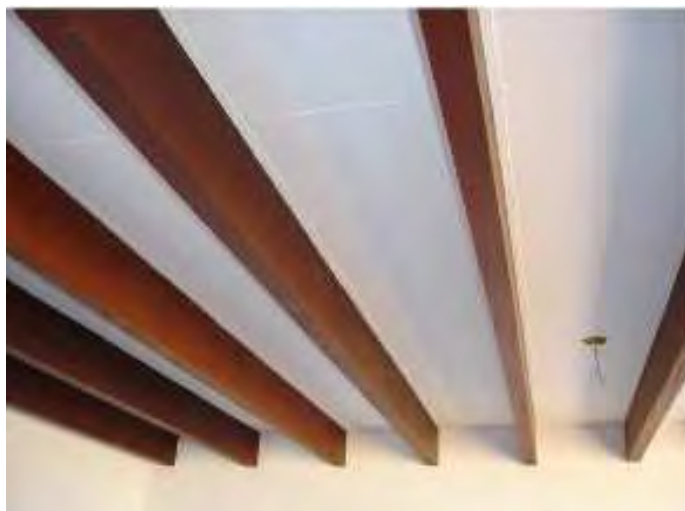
Vista de sistema de piso misto em madeira-concreto, com emprego madeira serrada de seção retangular. Fonte: Miotto e Dias (2006).
